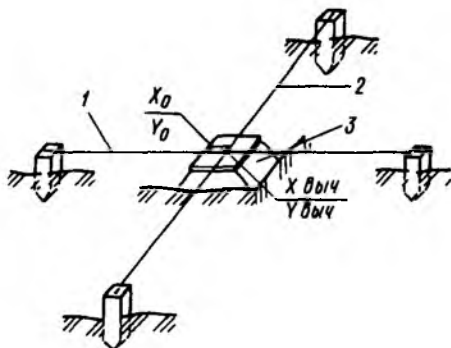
Закрепление железобетонными знаками вершин строительной сетки: 1, 2 – створы, 3 – знак
